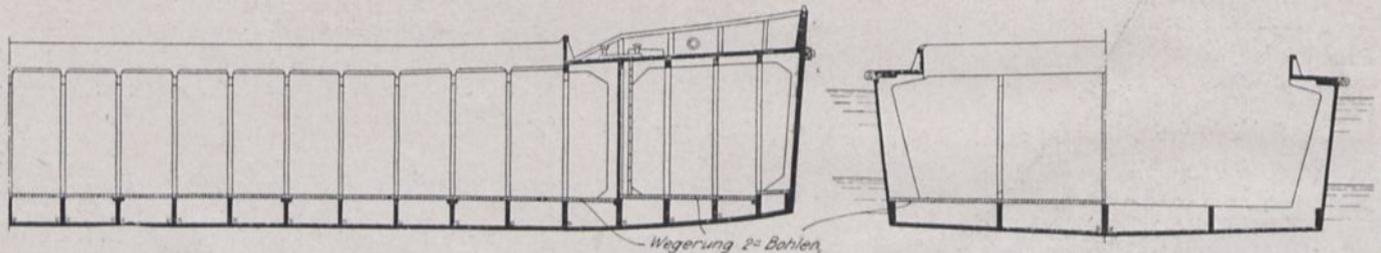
und 2. Längsschnitt und Spantenrisse des Eisenbetonschiffes.
